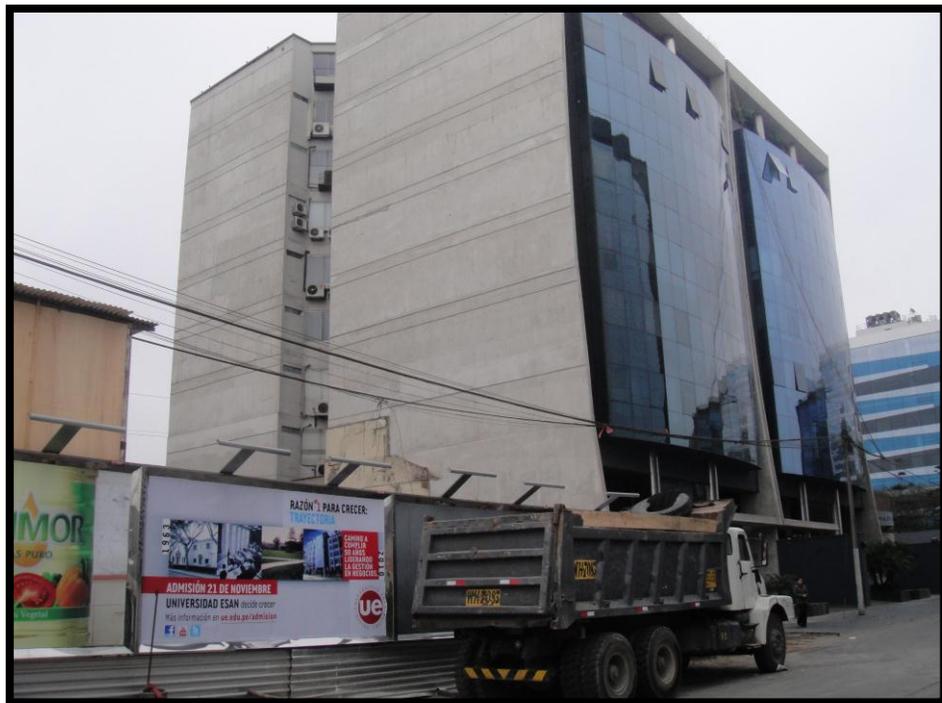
Por el lindero derecho el terreno limita con un edificio de 10 pisos que cuenta con 2 sótanos
